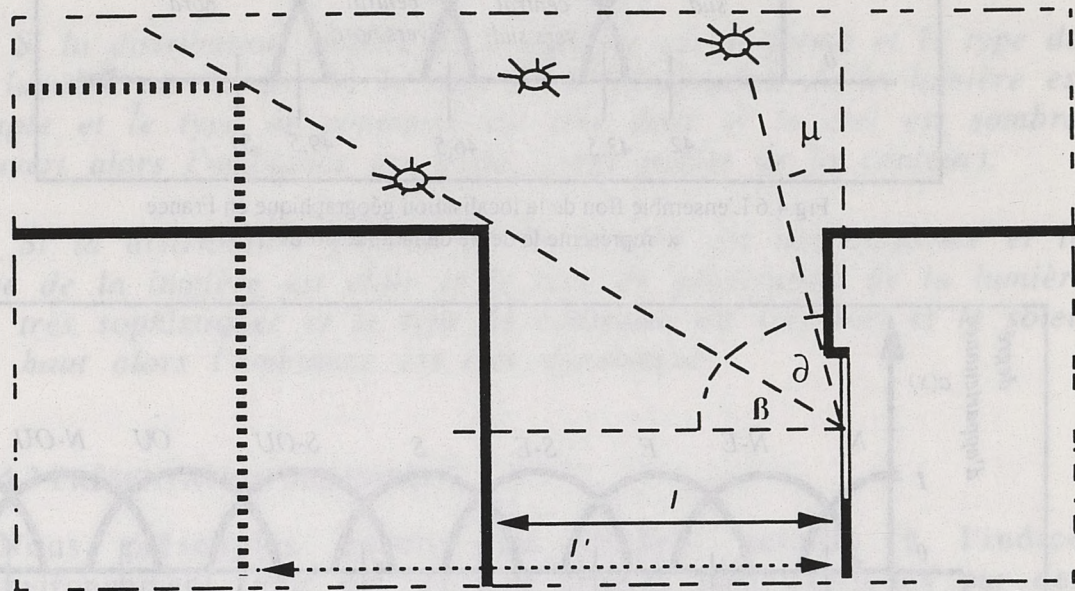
angle d'obstruction de la façade en face (β), angle d'enseillement (θ), angle d'obstruction du bâtiment lui-même (μ), distance de la façade en face (l, l')
